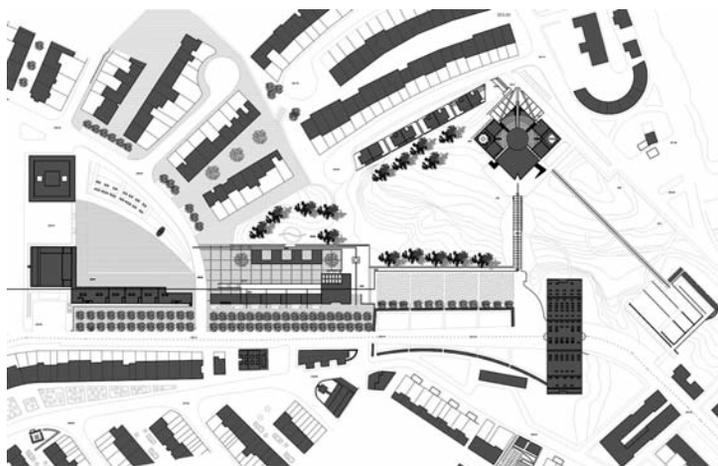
Planimetria del Centro Civico di Gibellina Nuova, Progetto
